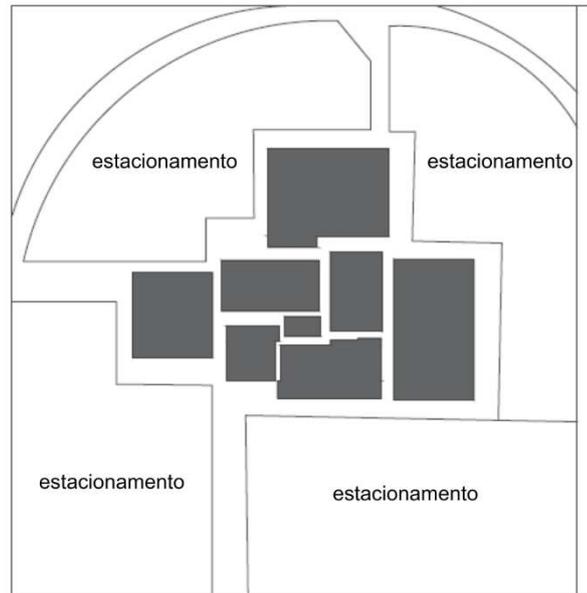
Planta esquemática do *Yorktown Shopping Center
